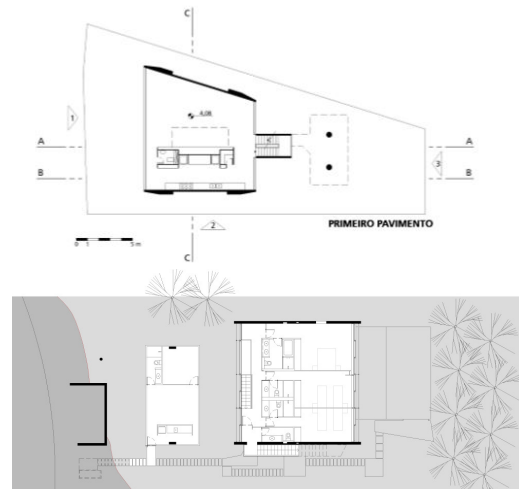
Plantas baixas das casas Pereira Corbett, Paulo Mendes da Rocha e Ubatuba II, Angelo Buccì
